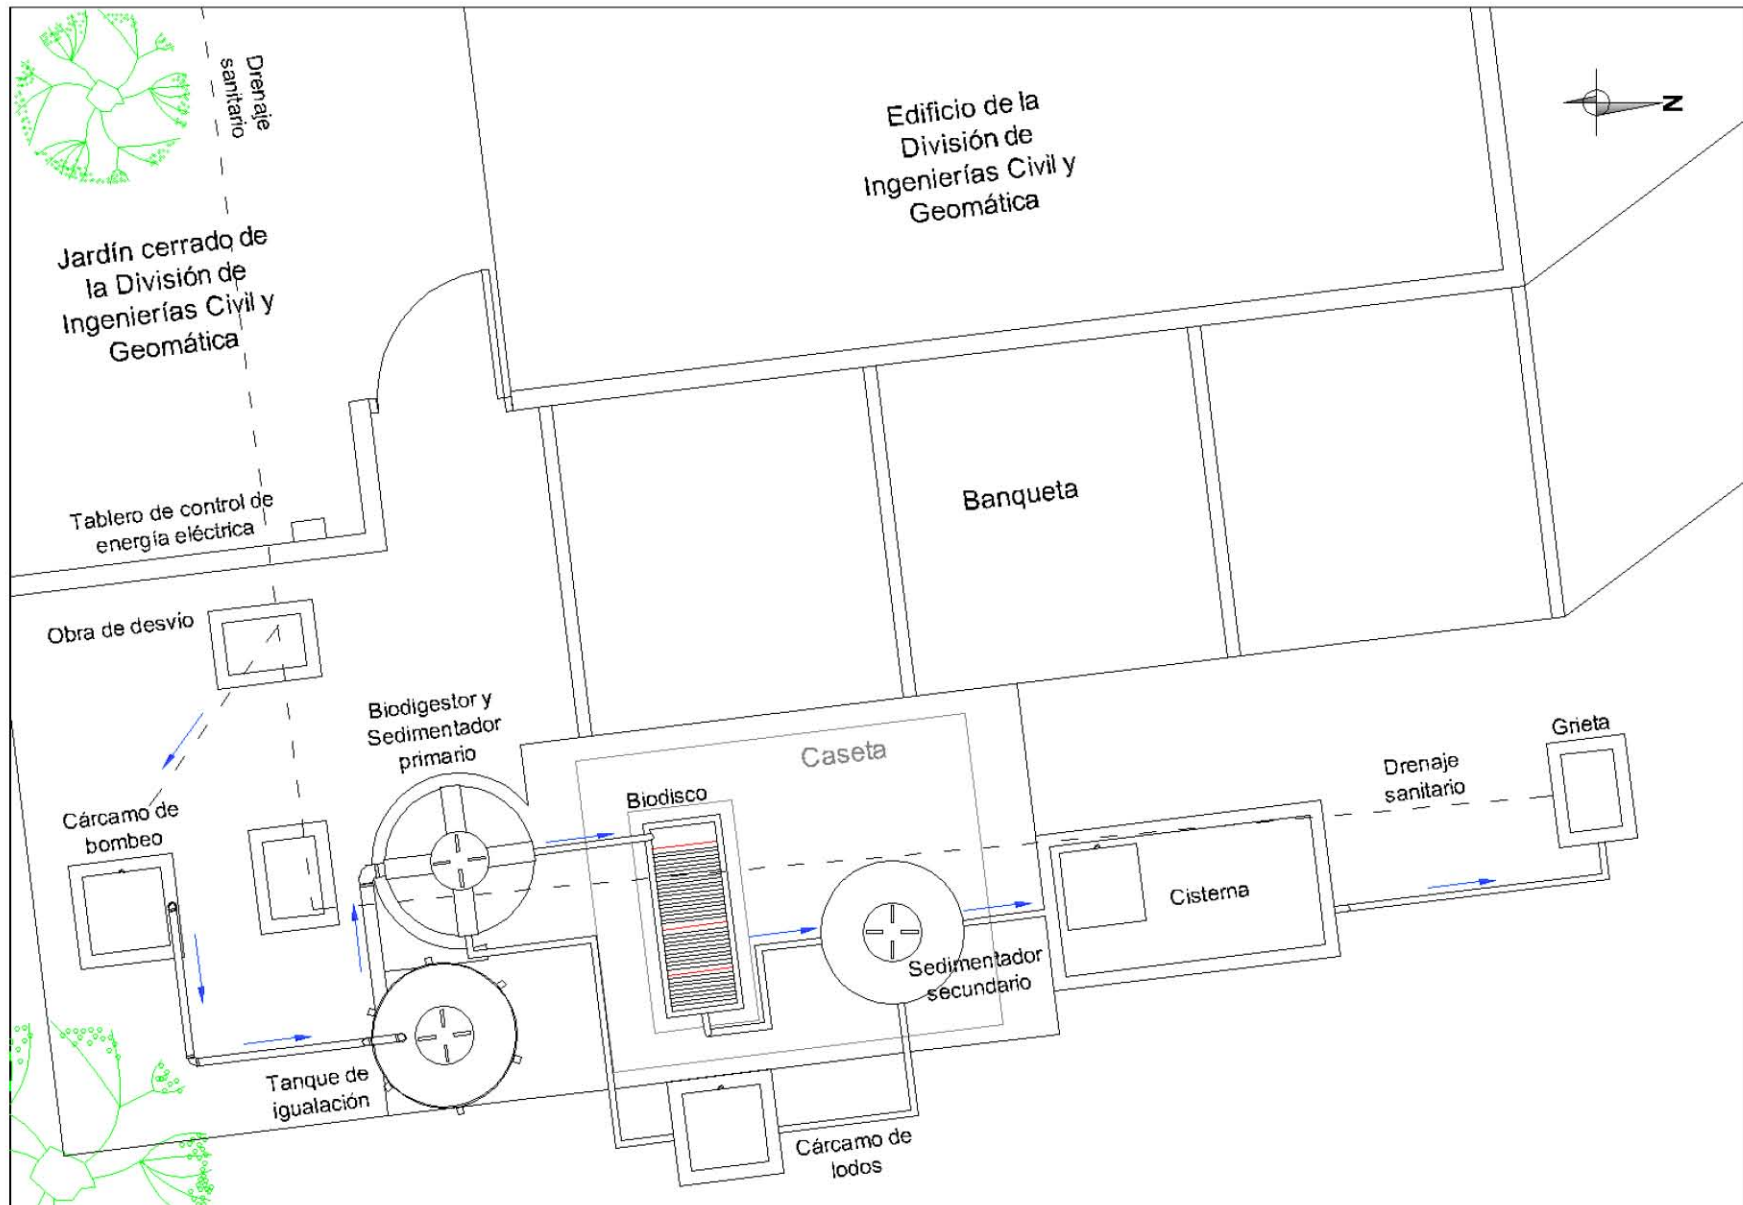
Vista en planta de las unidades de la planta piloto. Distribución propuesta originalmente
